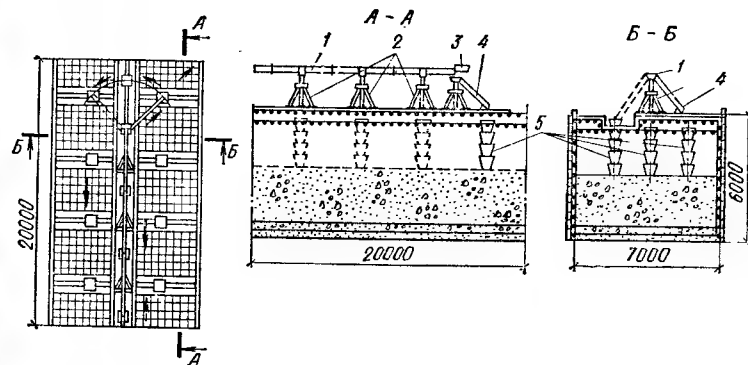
Схема бетонирования массивного фундамента с применением бетононасоса и звеньевых хоботов
